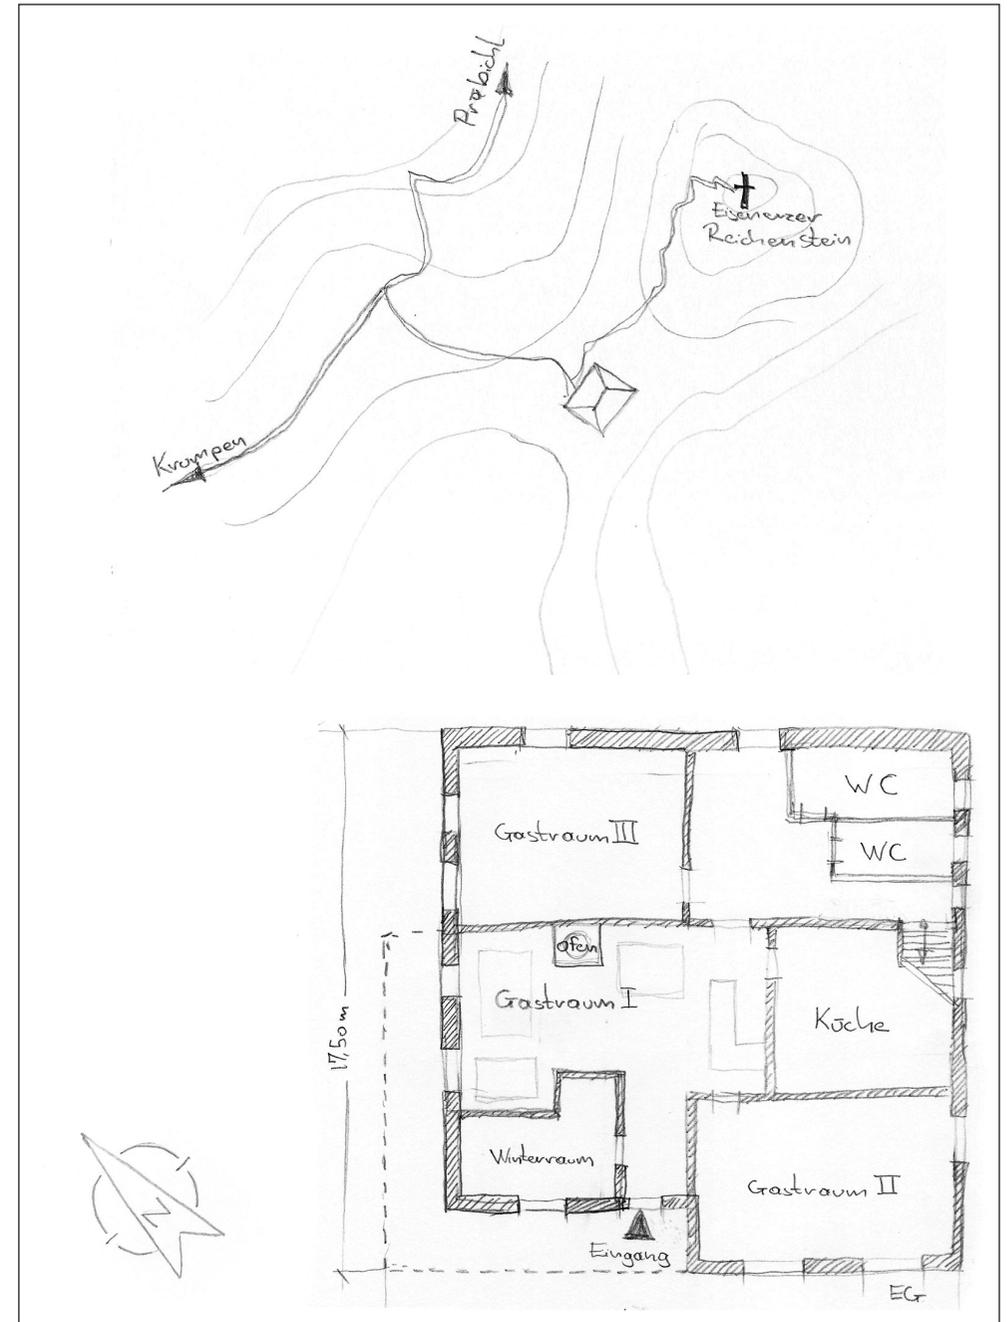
links: Skizze Lageplan und Grundriss Erdgeschoß
